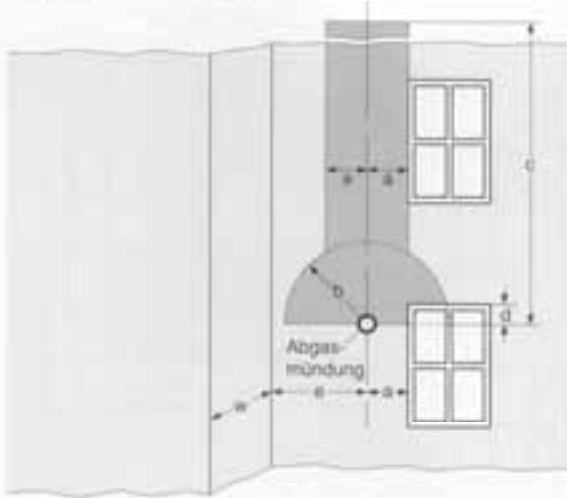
Mindestabstände von einer einzelnen Abgasmündung zu Fenstern, die geöffnet werden können, oder Fassadentüren – bei Fassaden mit Vorsprung
